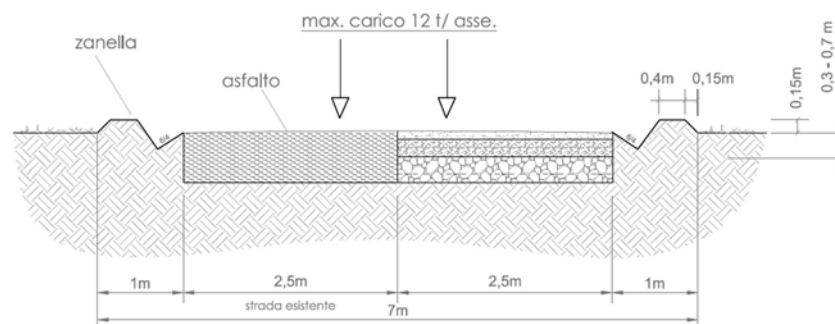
Sezione stradale tipo nel caso di allargamento della sede stradale esistente
